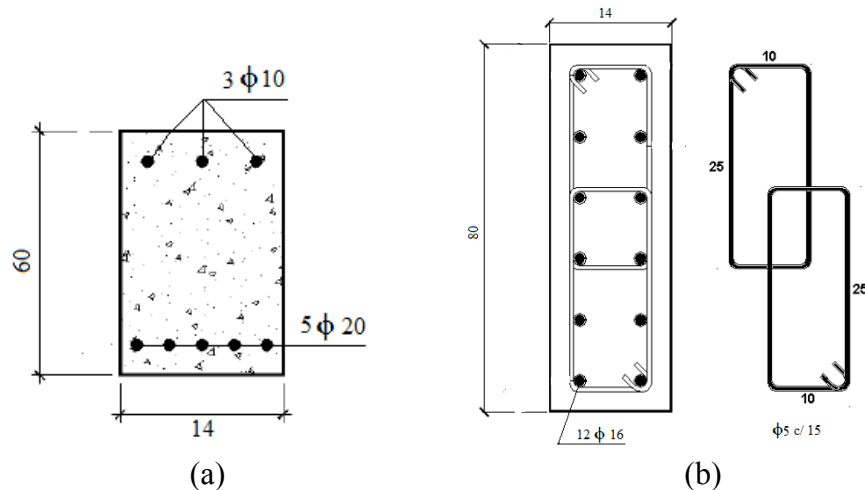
Detalhamento simplificado da seção retangular dos elementos estruturais: (a) seção retangular das vigas; (b) seção retangular dos pilares.
